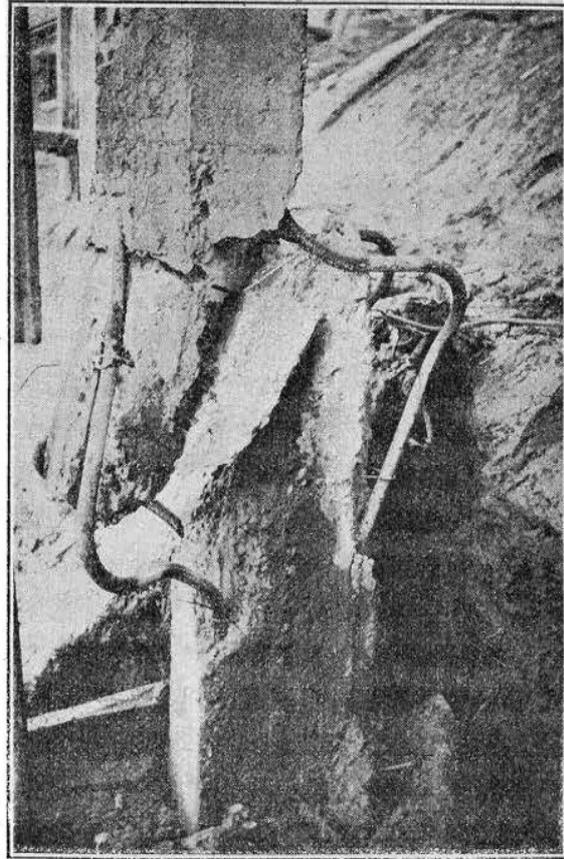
ª—Rotura de un pilote de hormigón armado,
